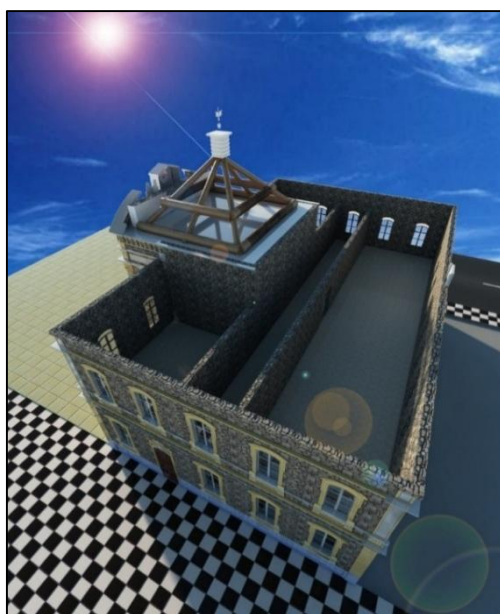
structure principale de la bâtisse, murs porteurs en pierre
